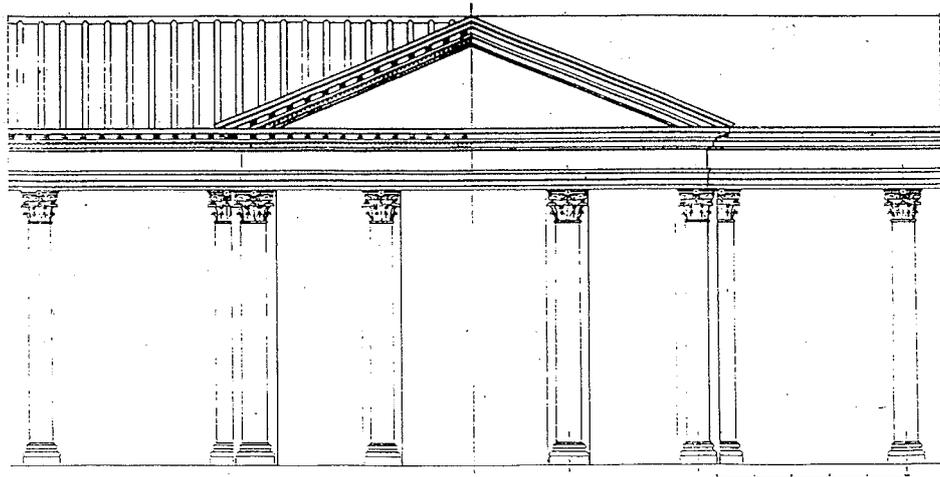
Reconstrucción de la fachada corintia del conjunto. (Arq. A. Rodríguez Calero).
